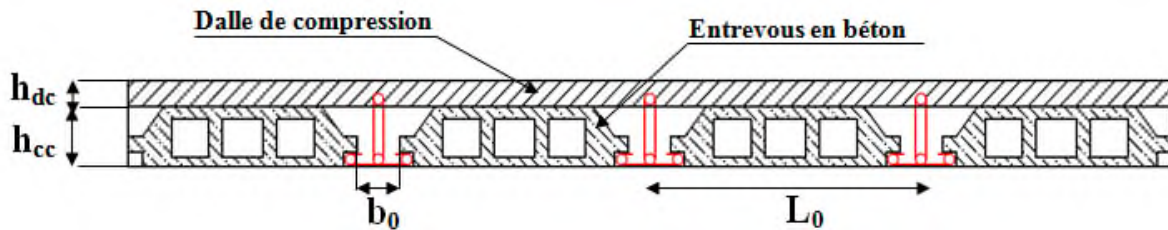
Coupe transversale d'un plancher à entrevous.
